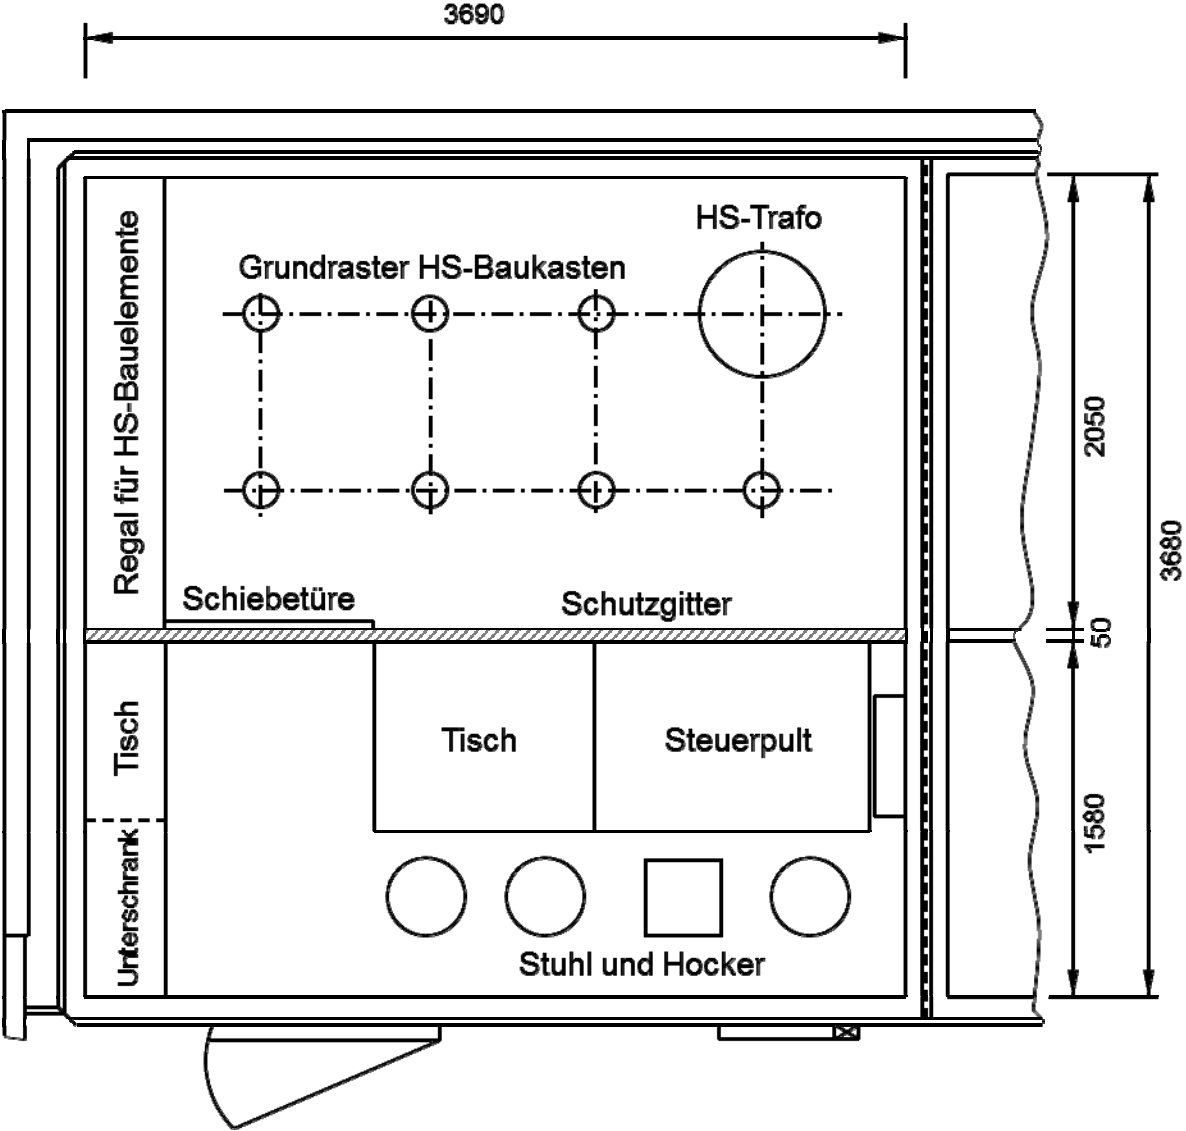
Grundriss eines 100 kV Experimentierstandes
